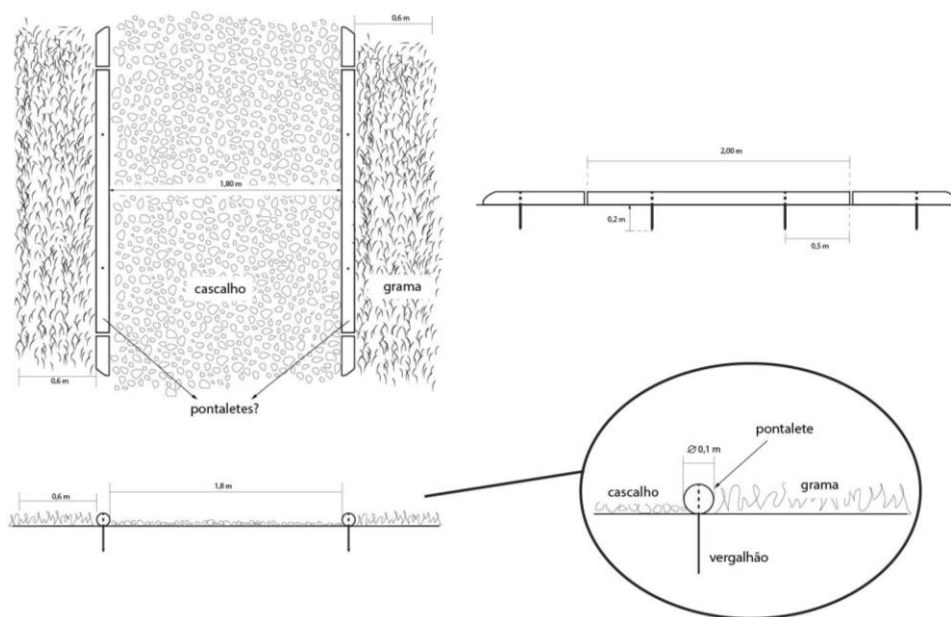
Foto da estrutura de bioengenharia de solo e elementos construtivos
